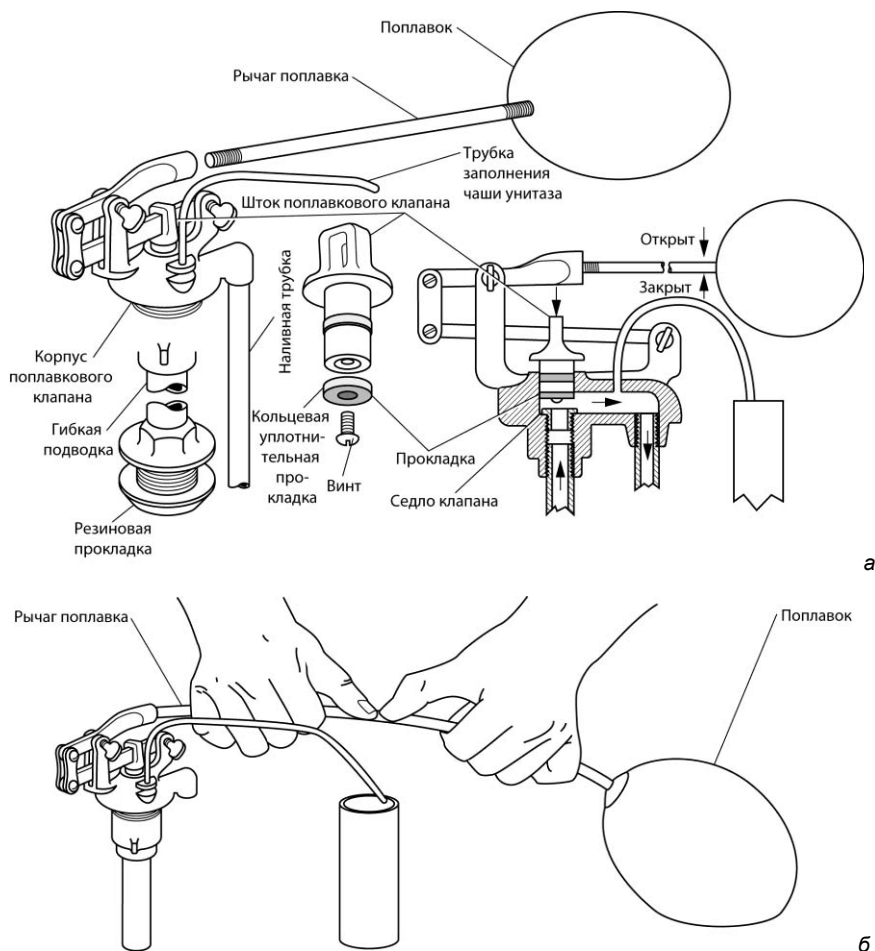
Стандартный плунжерный поплавковый клапан (а).
